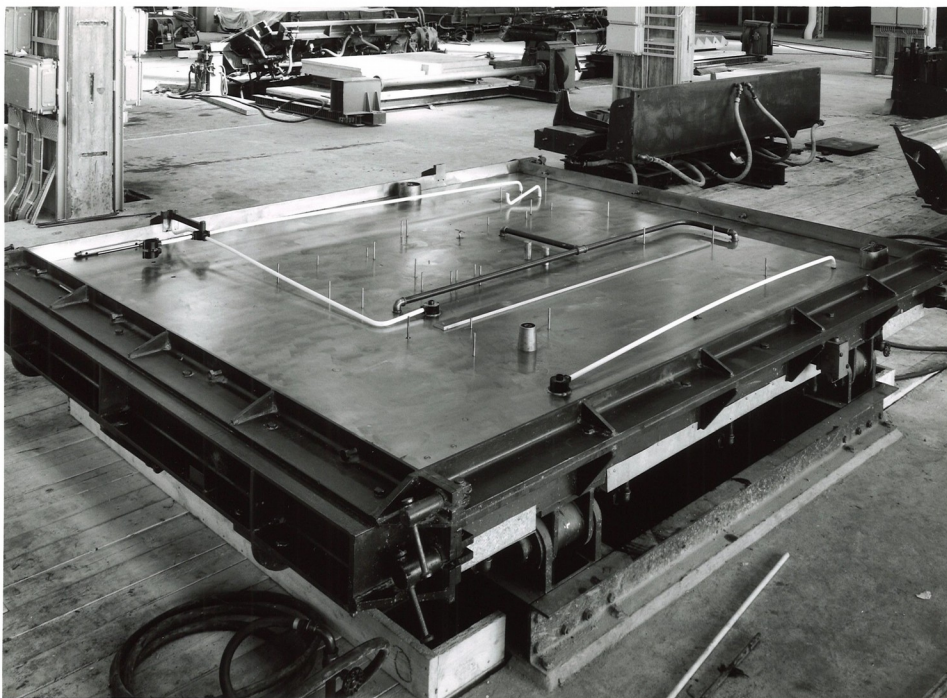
Wandform vor dem Einbringen des Betons mit bereits eingebauten Wasserleitungen und Leerrohren für Elektroinstallation, Lille
